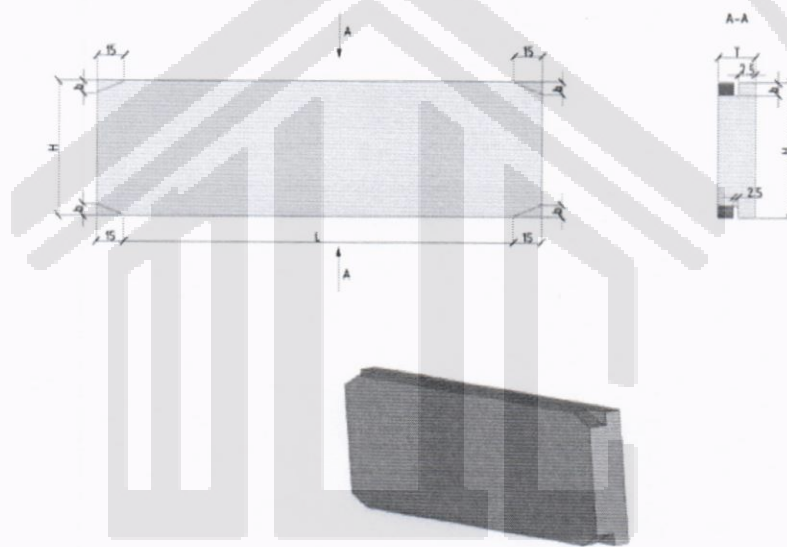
Общий вид и профиль поперечного сечения плитки «King Stone», тип А со скошенными углами (с монтажным пазом)
